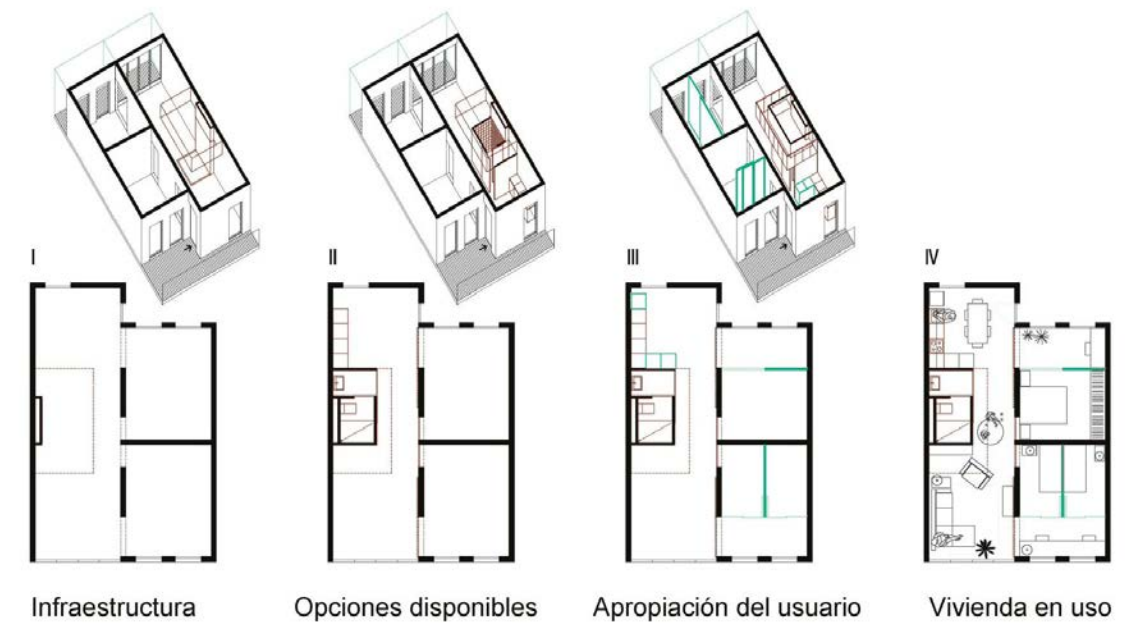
Planta arquitectónica de tipologías modulares. Fuente: La Borda, Cooperativa de viviendas en cesión de uso (2023)
